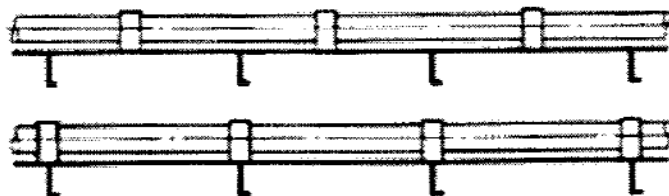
Montaggio corretto (sotto) ed errato (sopra) di staffe per tubi
